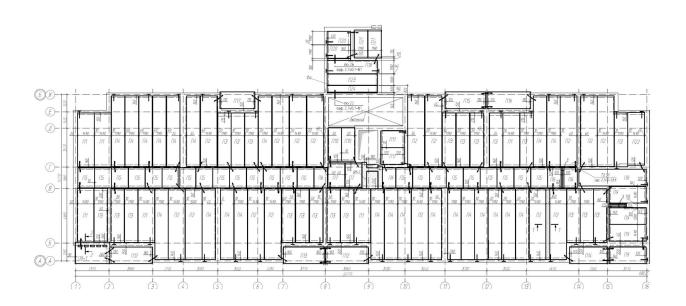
схема расположения плит перекрытия над подвалом
